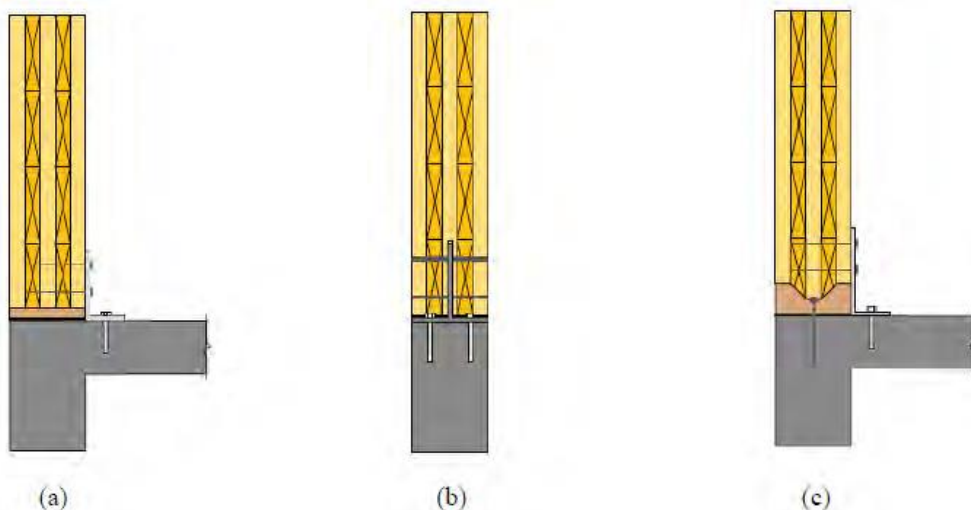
Ligação do tipo parede – fundação: (a) Ligação com uma cantoneira; (b) Ligação com um ligador metálico escondido; (c) Ligação com um perfil de madeira (Mandegarian e Milev, 2010).
